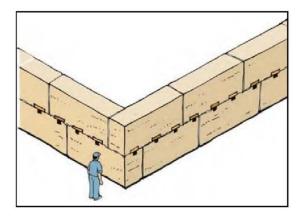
Encuentro entre muros perimetrales Fuente: (AIS, 2010)
